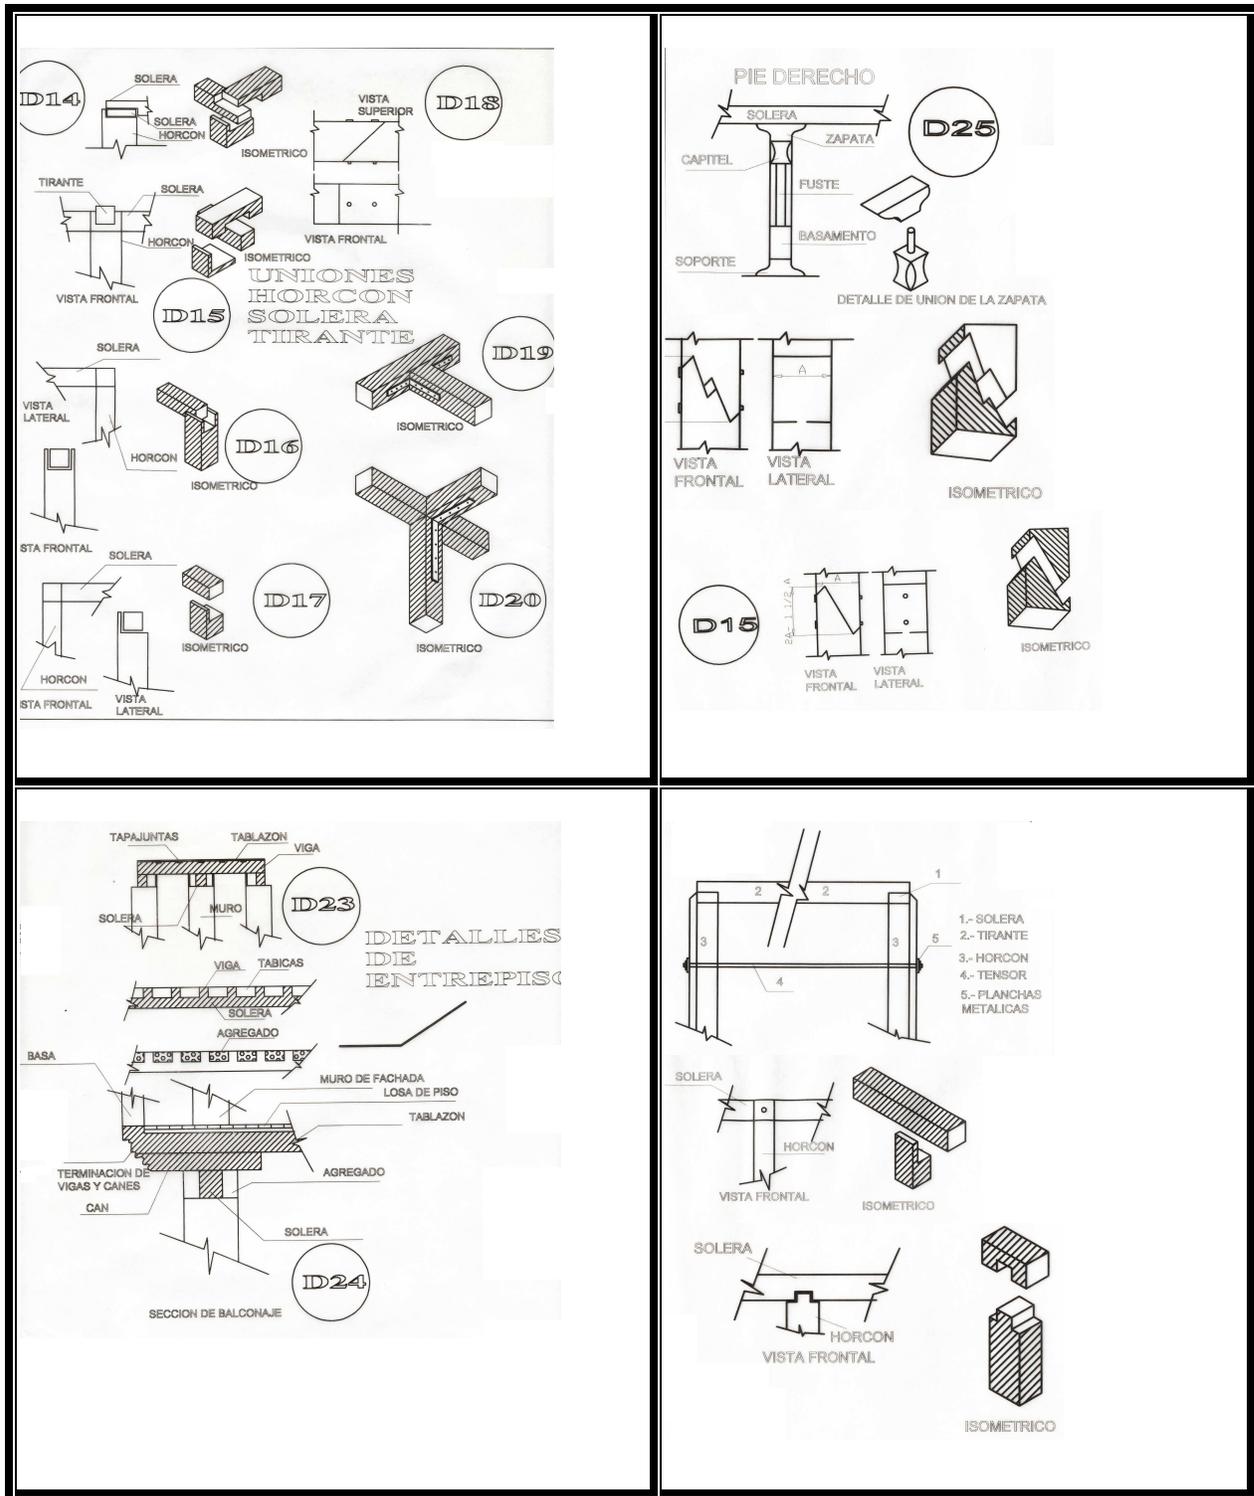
Detalles técnicos constructivos de las viviendas <sup>40 84</sup>.
